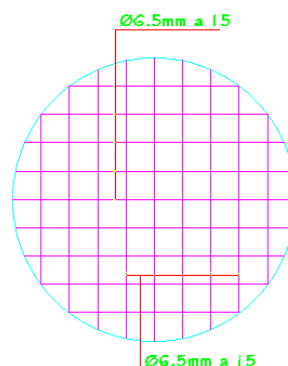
Detalles en el refuerzo de la losa de cimentación
